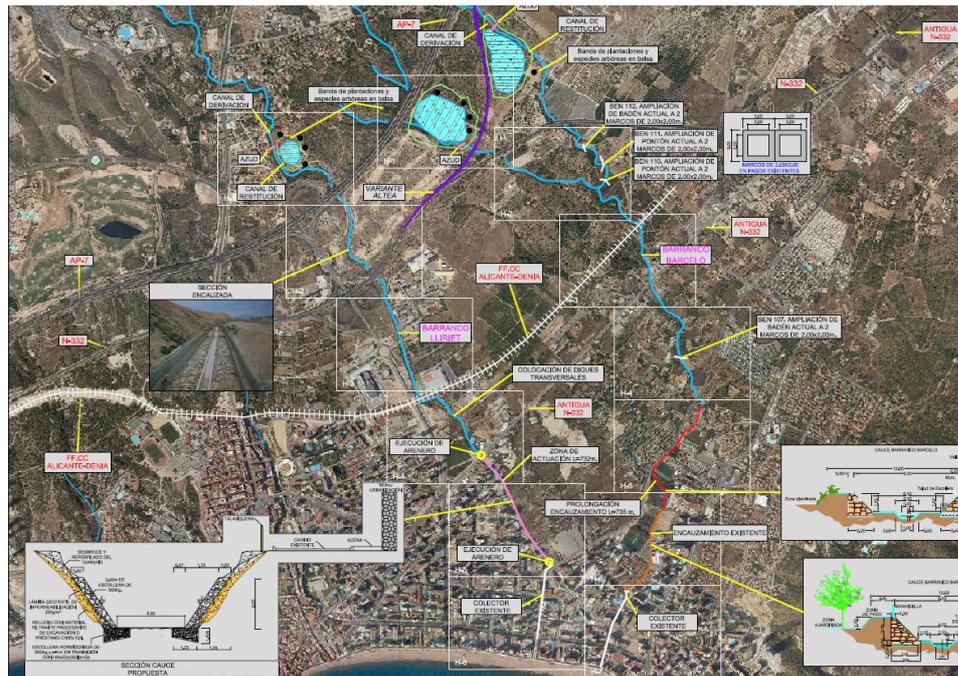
Planta de las actuaciones previstas en el PDMB para el barranc de Liriet.
